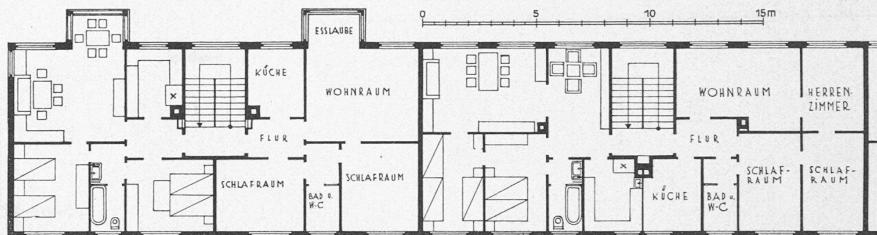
Grundriss-Typen des Stahlskelett-Baublocks. — Maßstab 1 : 300.
